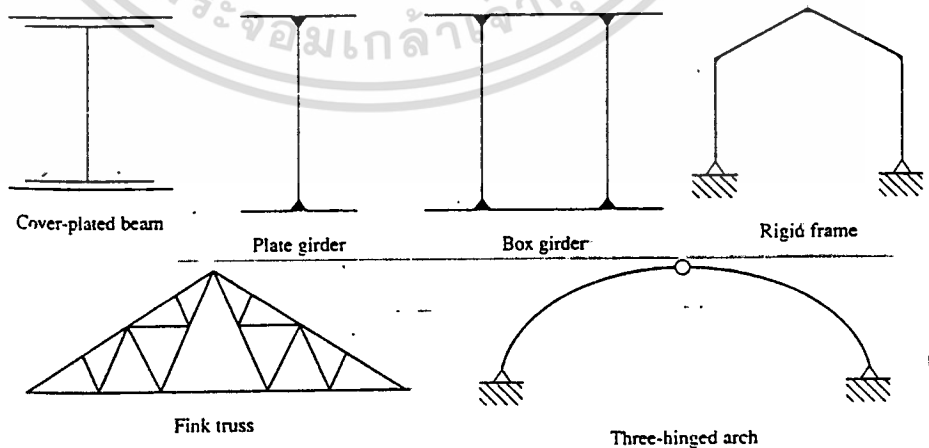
แสดง โครงสร้างแบบ beam-and-column construction
